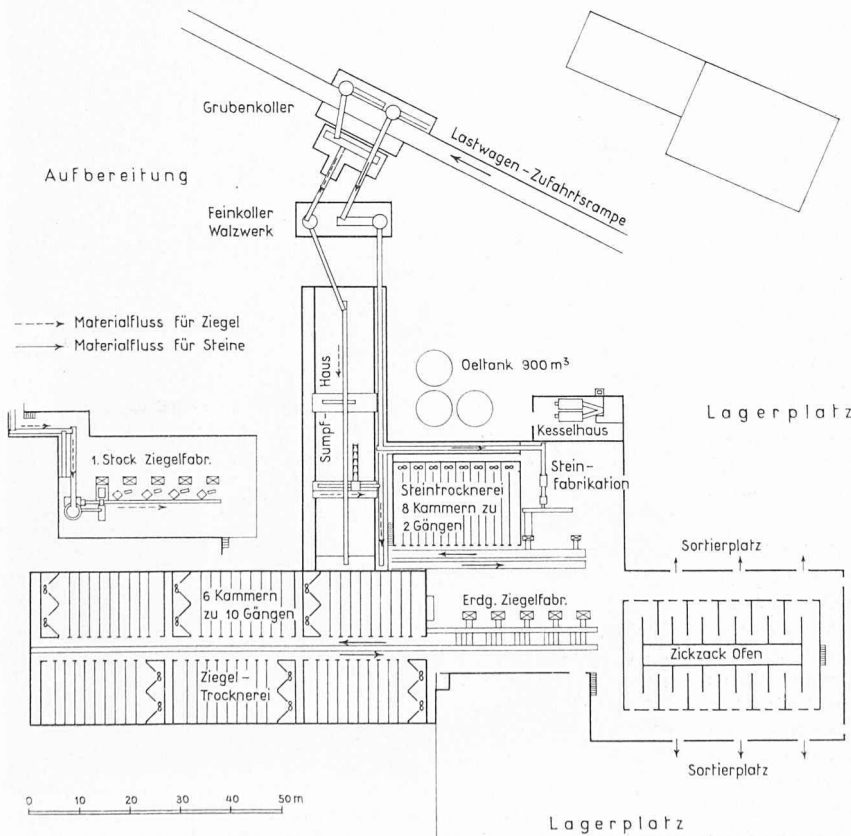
Lageplan der Anlagen, Masstab 1:1500
